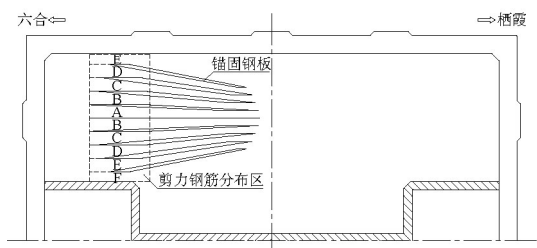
钢筋混凝土棒区域混凝土浇筑分区示意图
